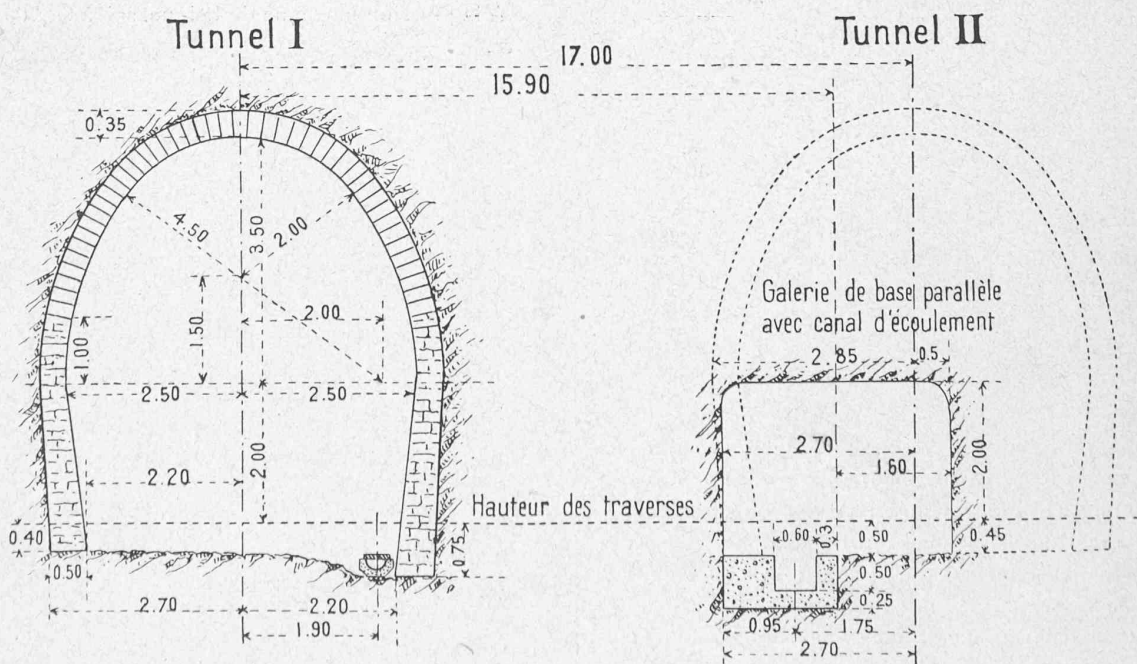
Tunnel du Simplon. — Profil-type du tunnel I et galerie parallèle avec canal d'écoulement.
